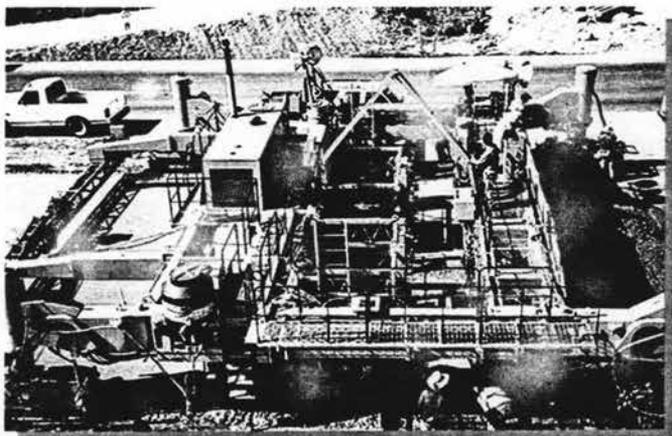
Pavimentadora Slip Form Paver (CMI-SF-450)
